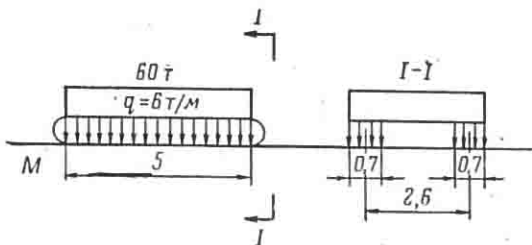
Гусеничная нагрузка по схеме НГ-60
